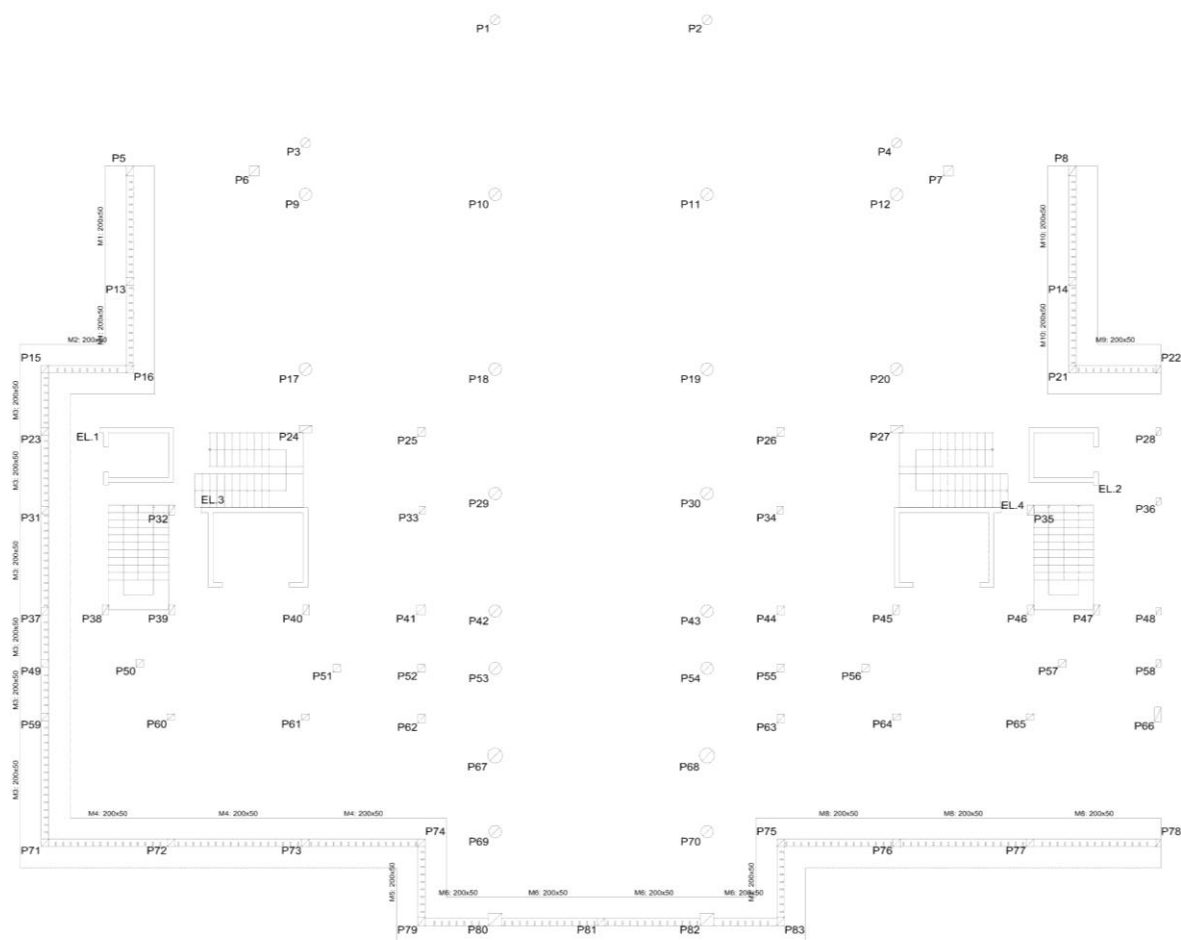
Planta estrutural do piso térreo da Cave: corpo E (s/escala).
